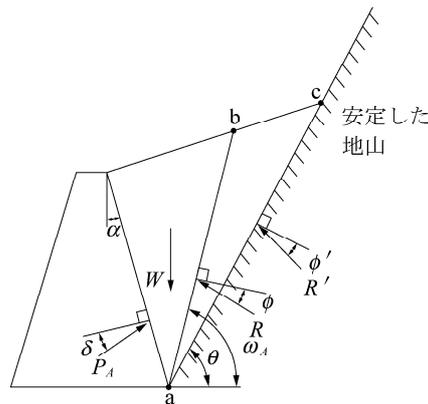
切土部土圧の算定法 (その 1) ⁸⁾
